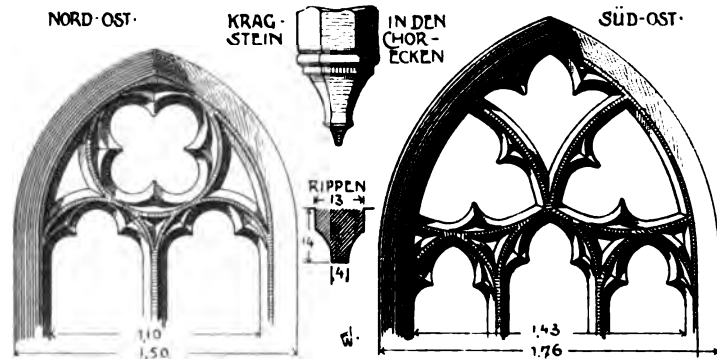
Velburg. Fenstermaßwerk und andere Details aus dem Chor der Pfarrkirche.
